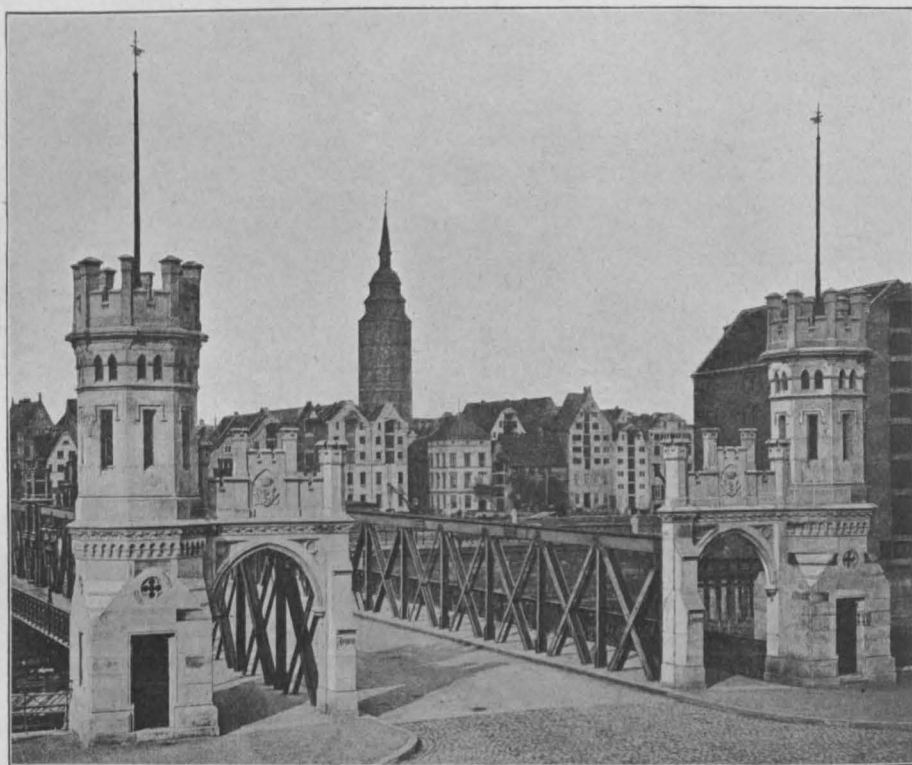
Kaiser-Strassenbrücke in Bremen. SCHWEDLER. 1874.
